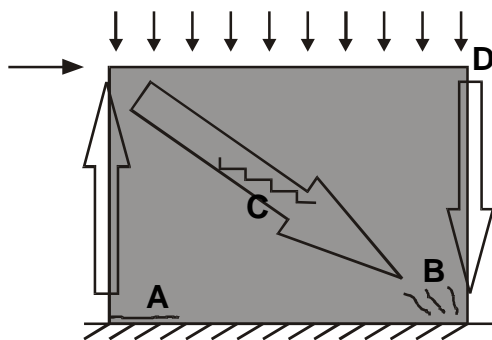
Fissurations possibles d'un mur cisailé et transfert d'efforts
